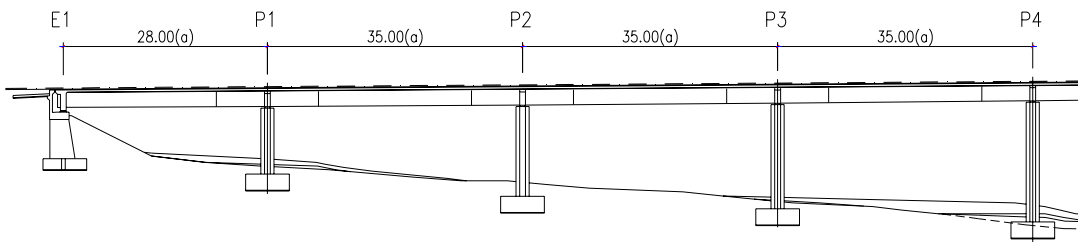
Corte Longitudinal do VIADUTO DE MESSEJANA (1)
